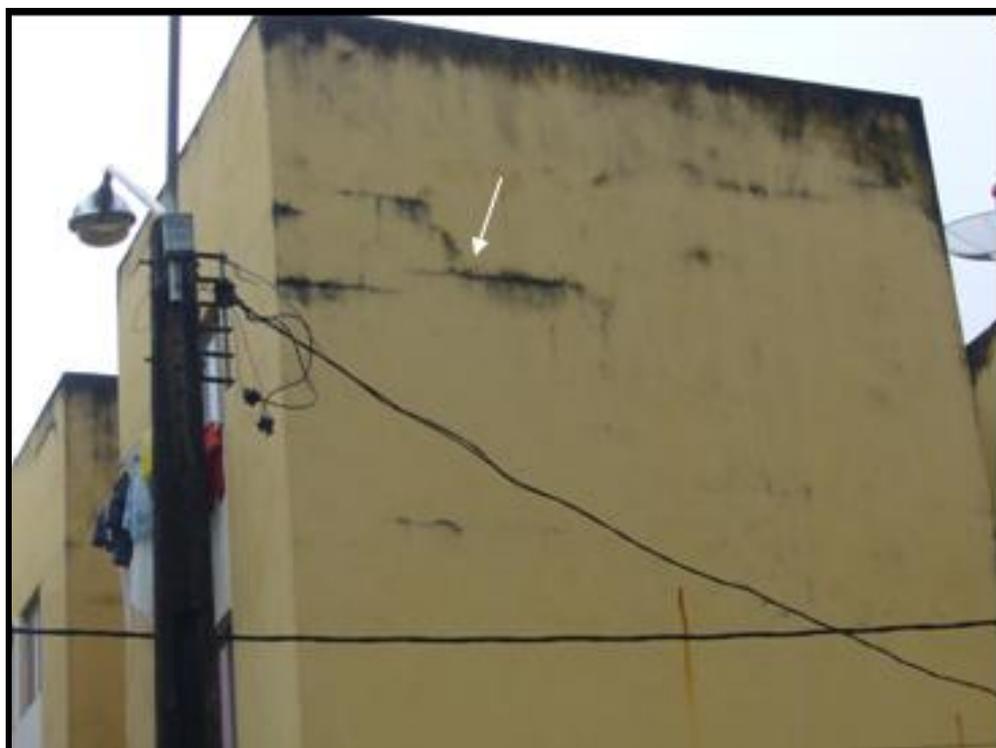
fissuras horizontais na região superior da fachada
